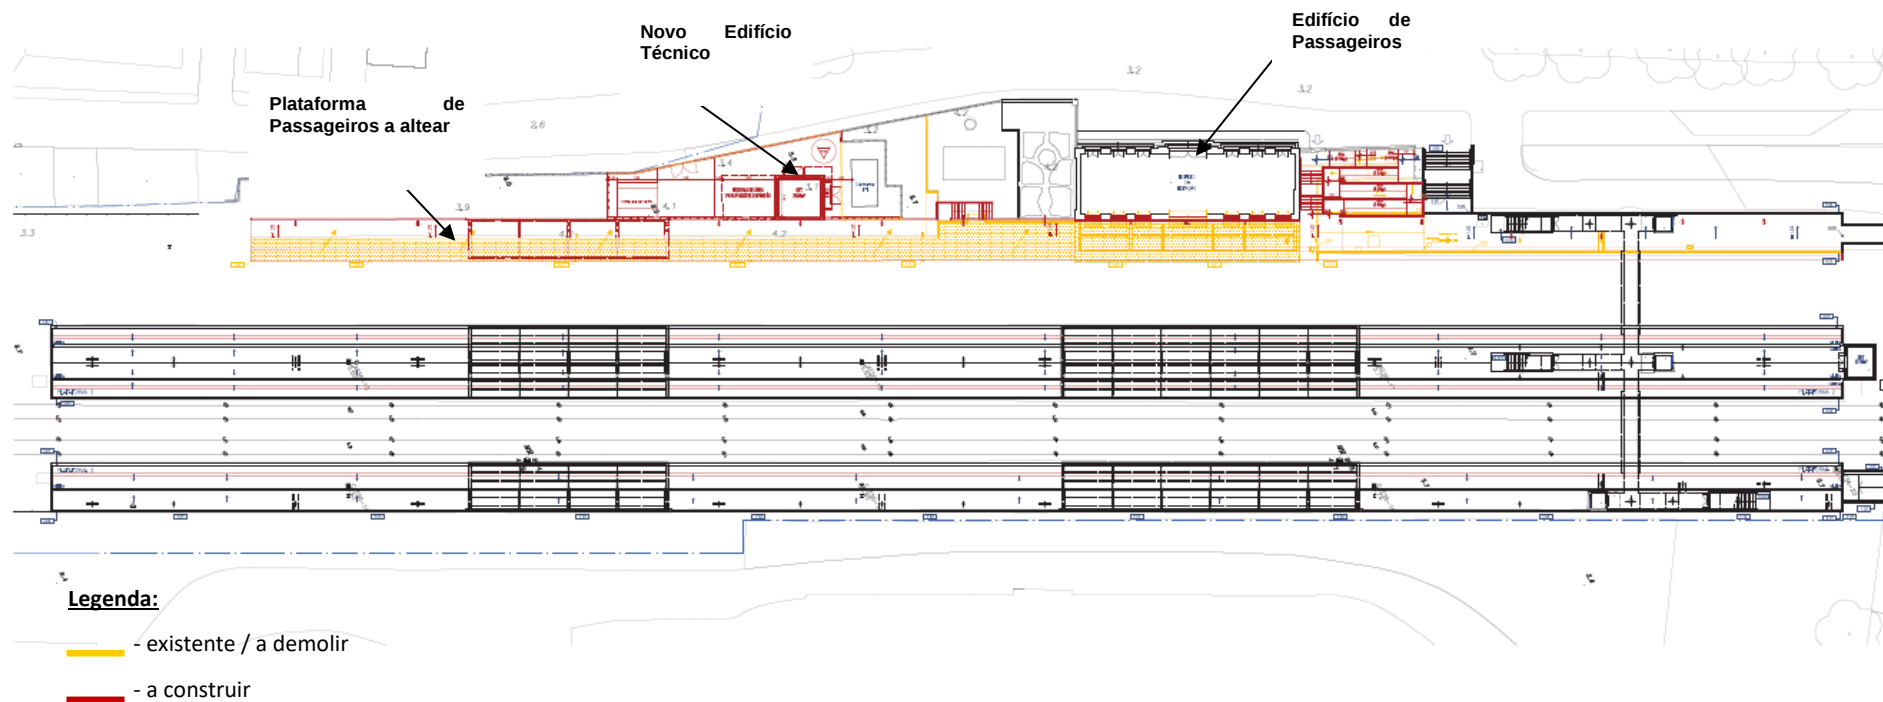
Layout do apeadeiro do Carregado e proposta de intervenções
